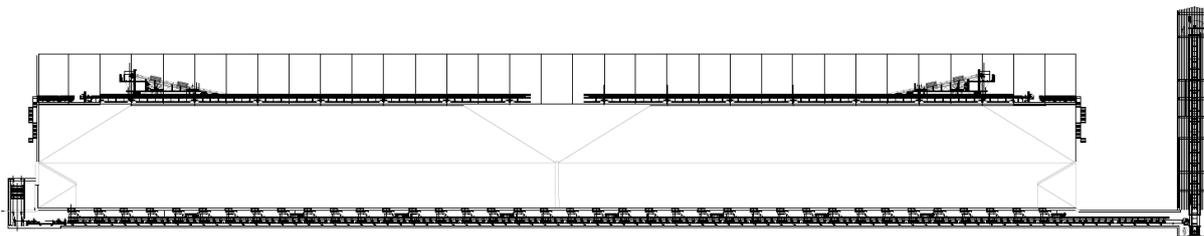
Corte Longitudinal do Armazém Novo 182.000 toneladas
